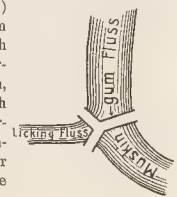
Lageplan der alten Holzbrücke zu Zanesville (O.).
